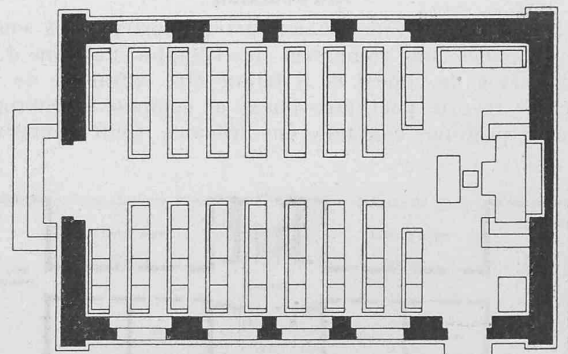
Chapelle de Duillers. — Plan. — Echelle 1 : 125.
